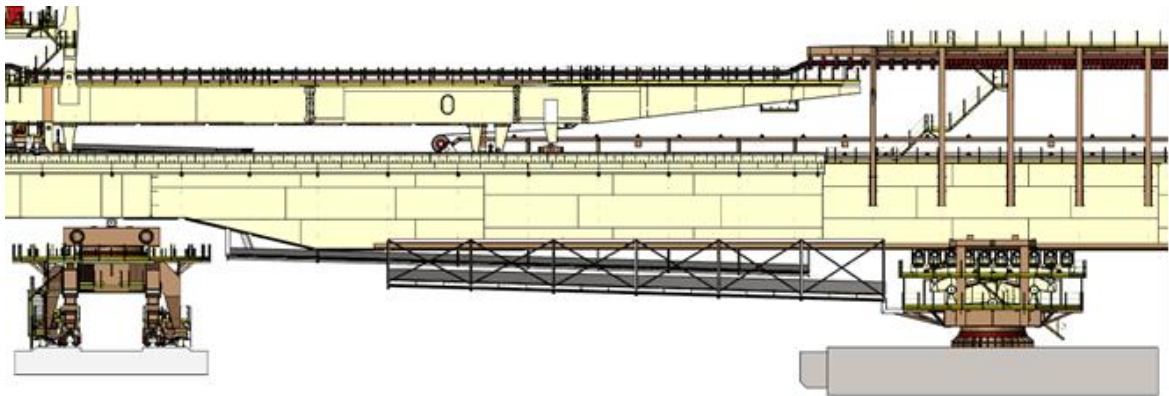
Estruturas das calhas fixadas na máquina [posição recuada] – modelo CAD 3D.
